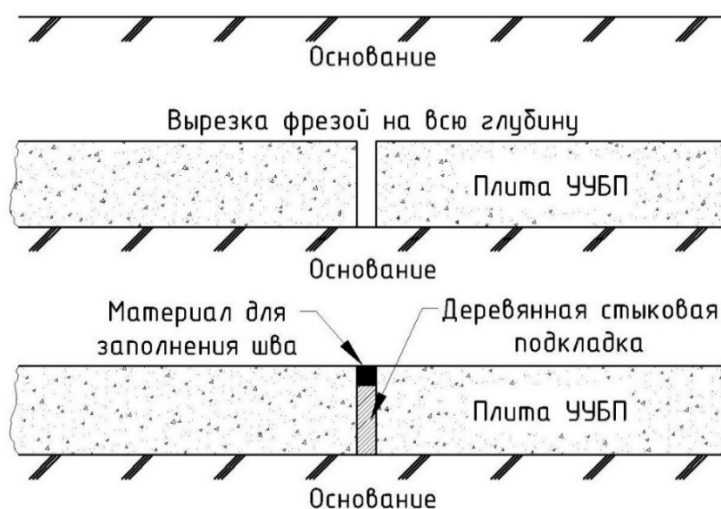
Пример порядка строительных работ поперечного шва
